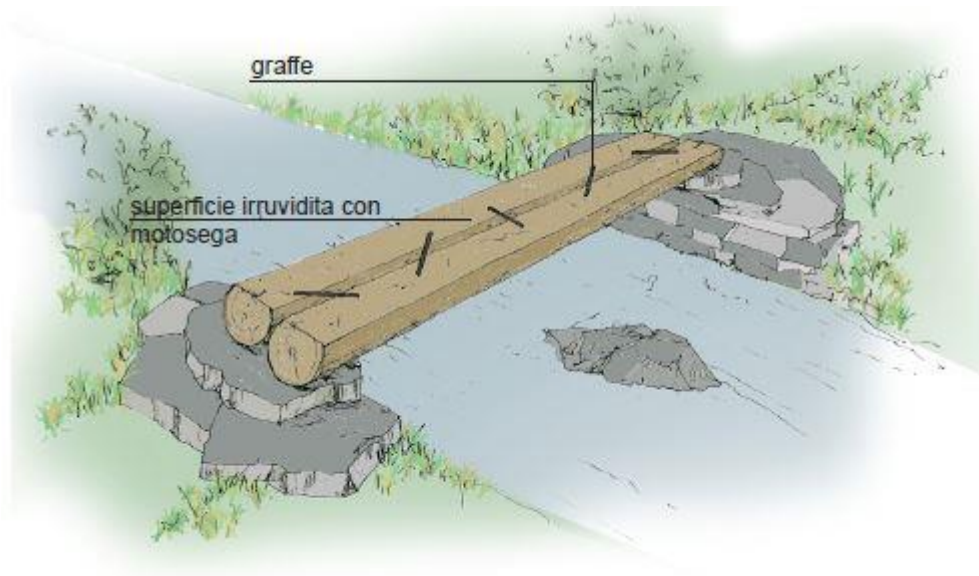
esempio tipologico di passerella in travi su spalle in roccia
